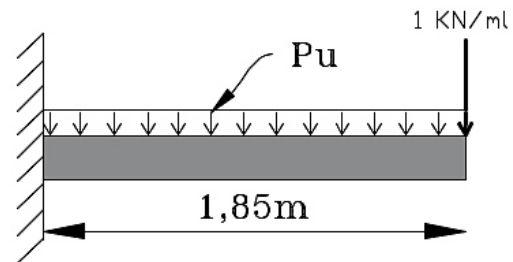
Schéma statique de la dalle sur 3 appuis.
